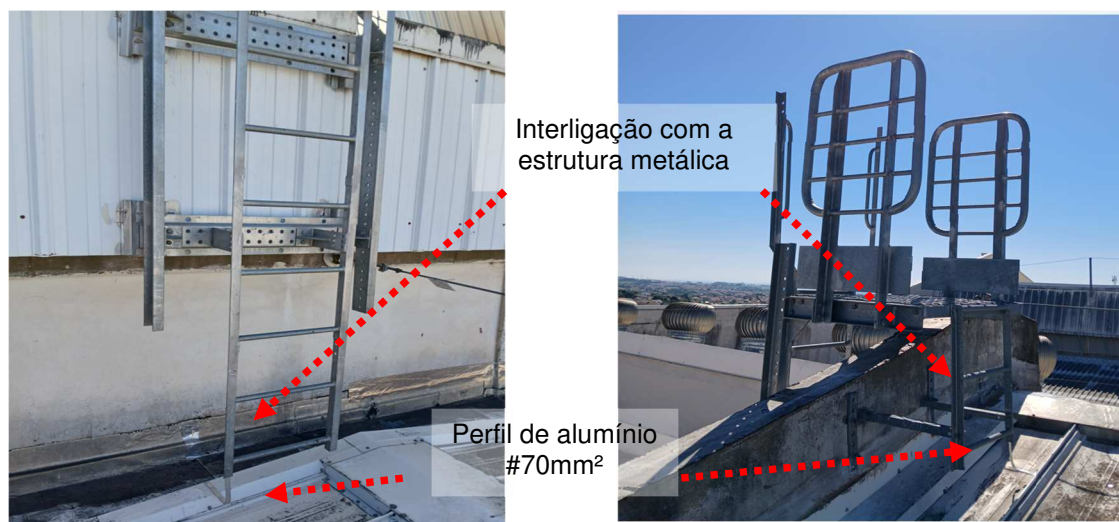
e 147: Malha captora natural - (Capas de muro metálicas).
